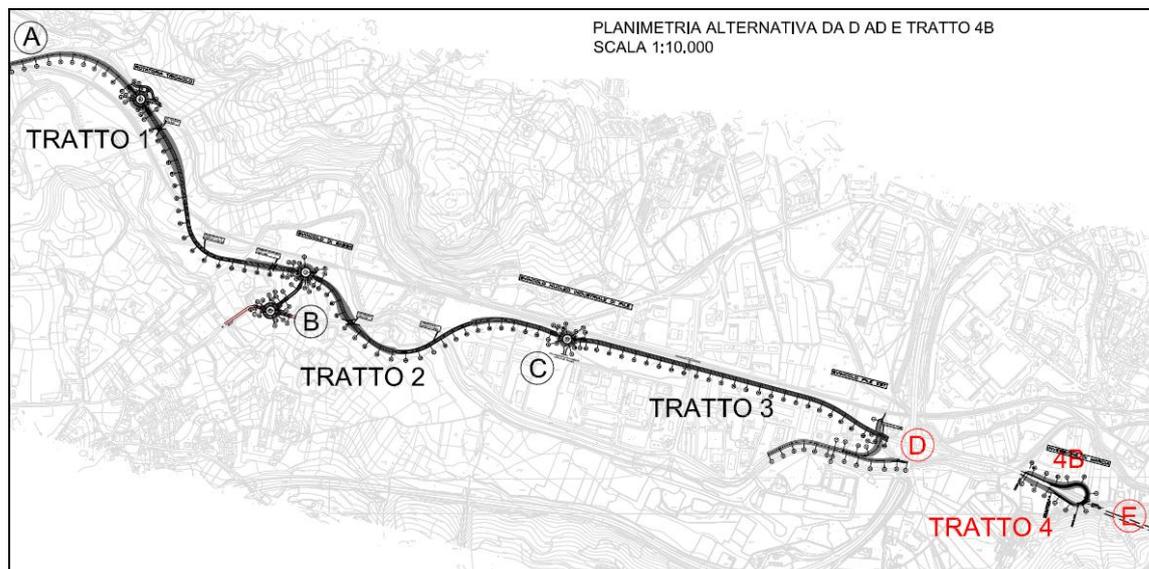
Planimetria LOTTO A con Alternativa di progetto 4B
